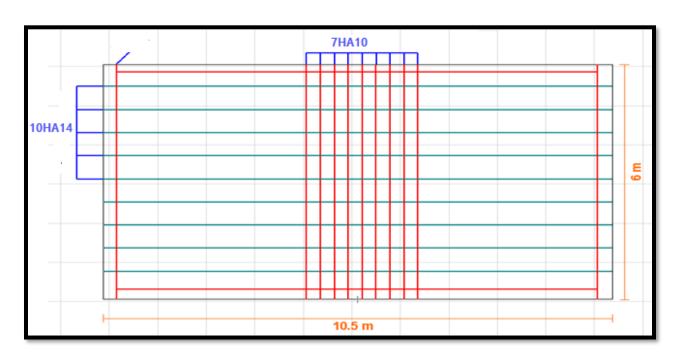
Ferraillage de la semelle – nappe supérieure
